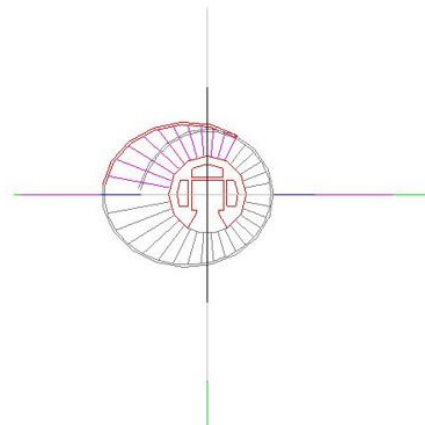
Plano de AutoCAD importado a Revit (Nivel Planta)
